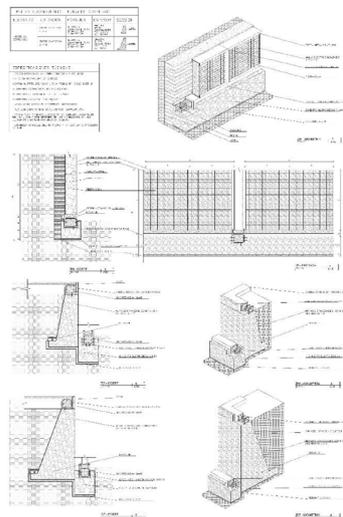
Cortes constructivos de un muro de gravedad en hormigón ciclópeo.
